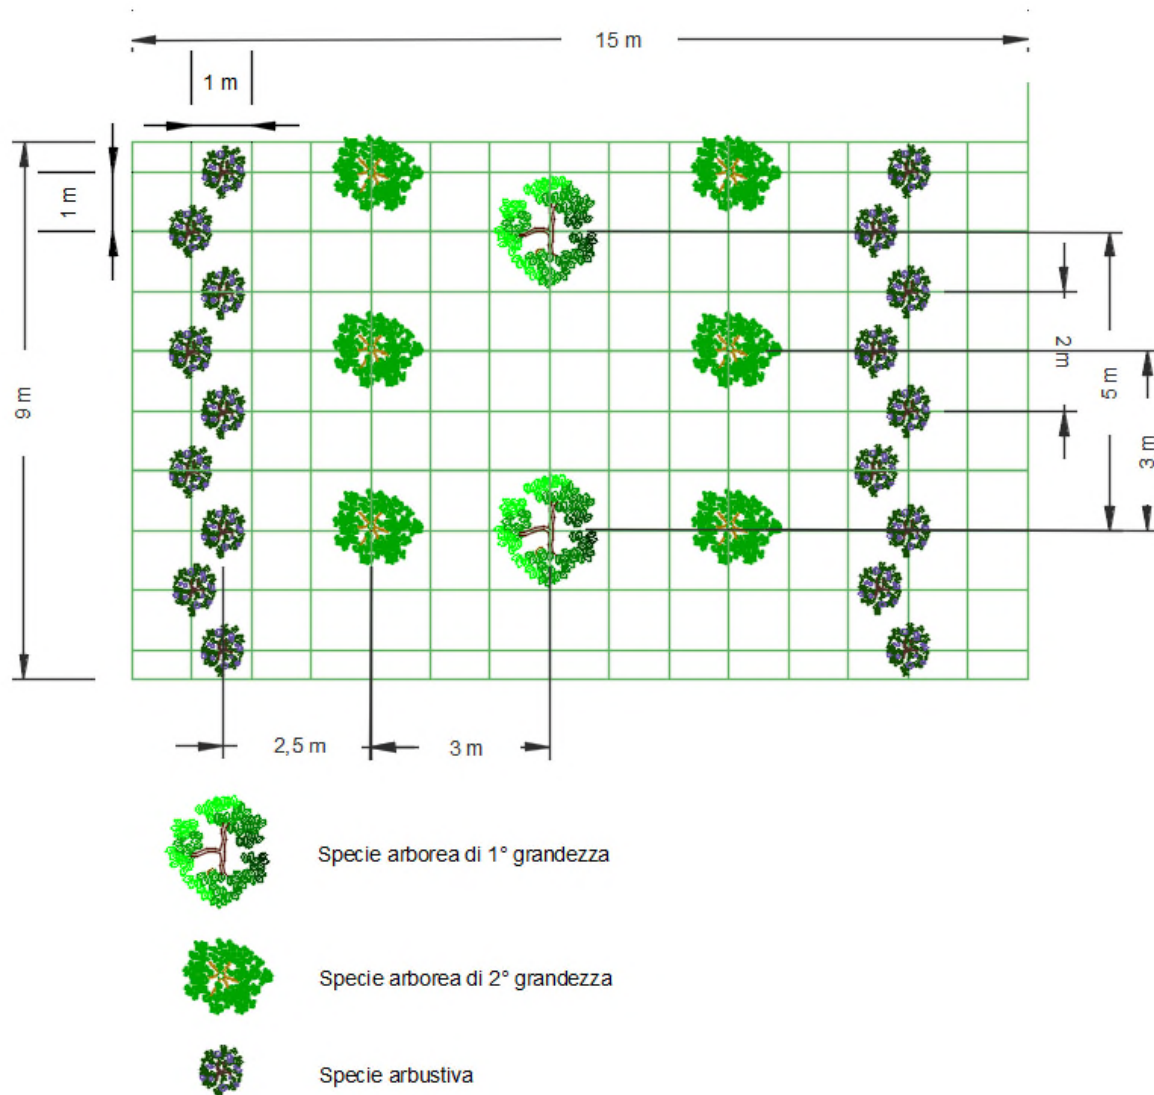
Modulo e sesto d'impianto della fascia schermante con struttura “a tetto”
